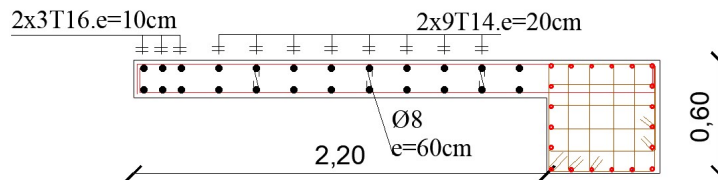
Exemple de ferrailage du voile RDC (L= 2.20 m)
